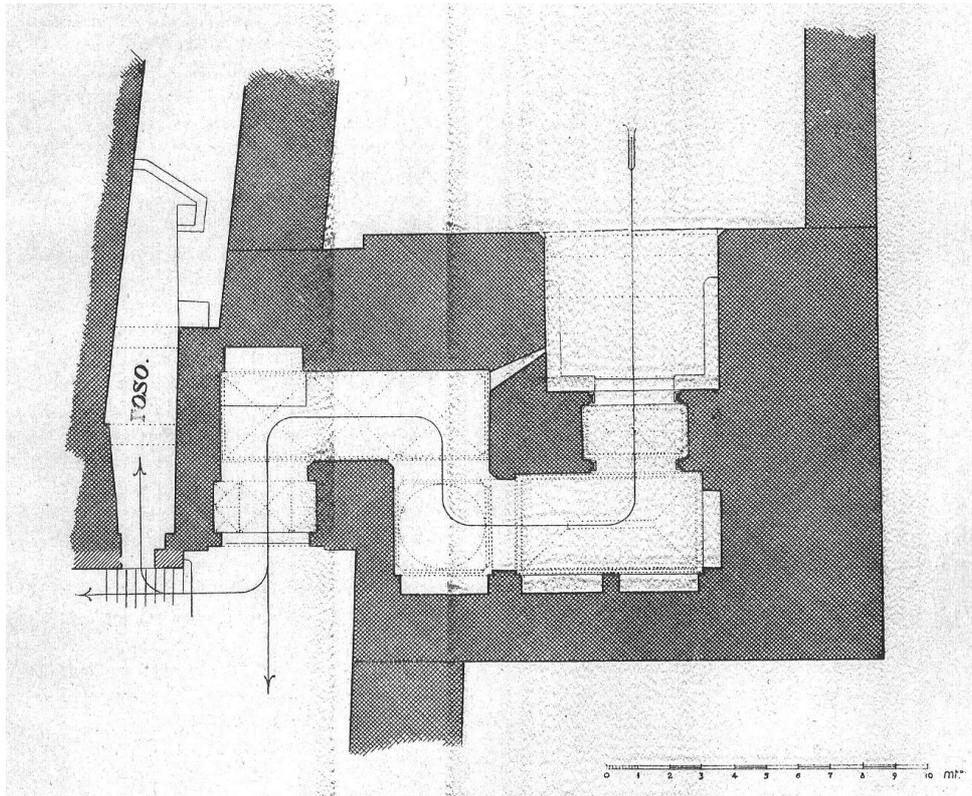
Abgewinkelter Durchgang, Puerta de la Justicia (Alhambra), Grundriss
